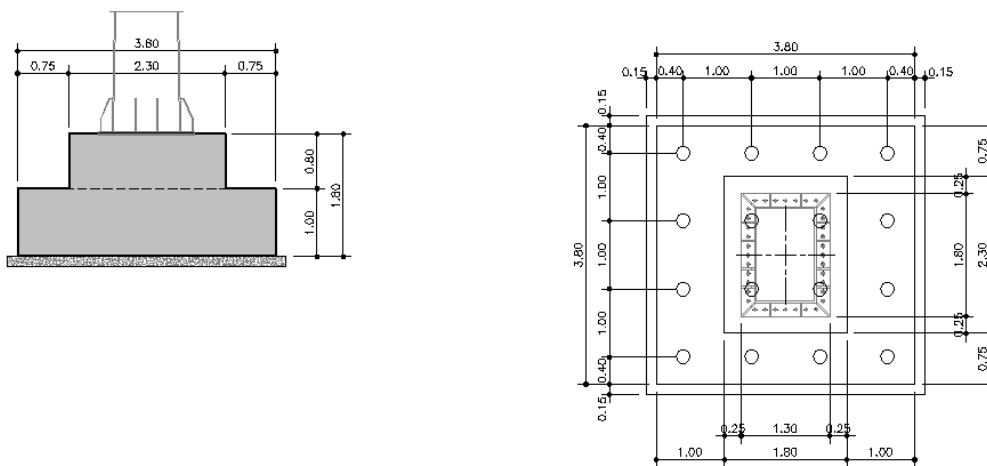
Carpenteria del plinto di fondazione - Posa in piano
